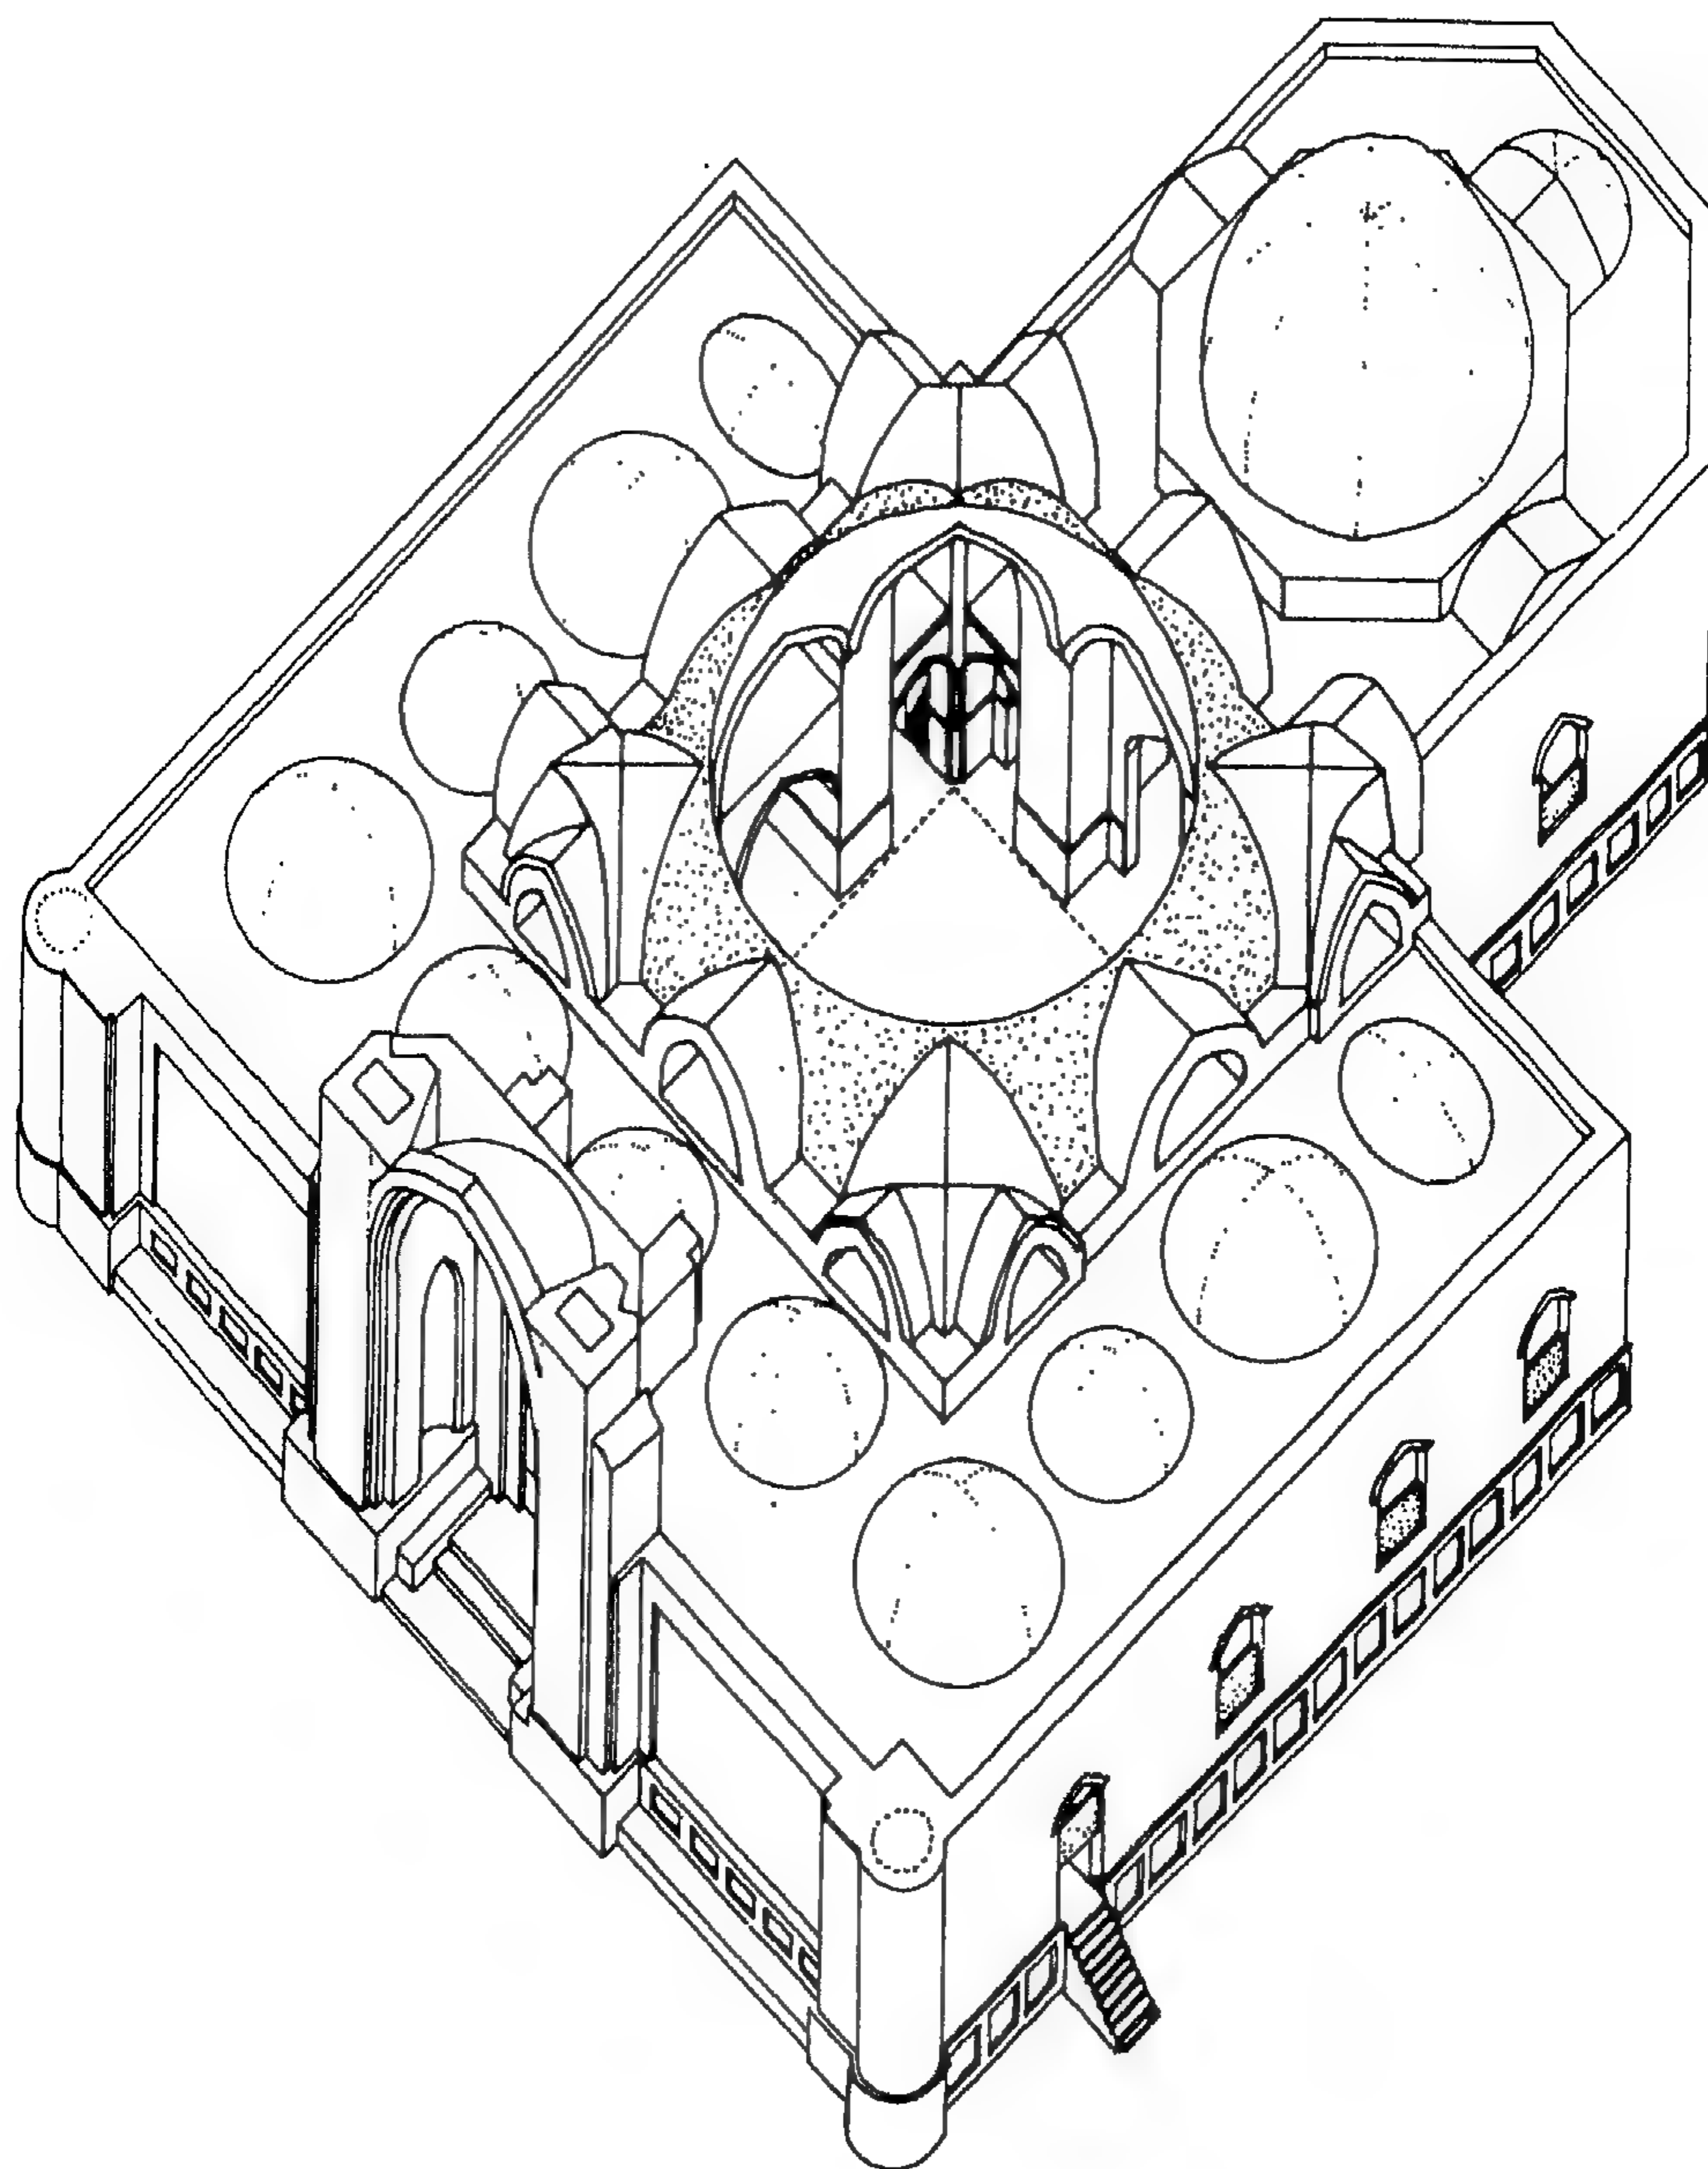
مسقط أفقي لعمارت ميخال أو غلو محمد بك
